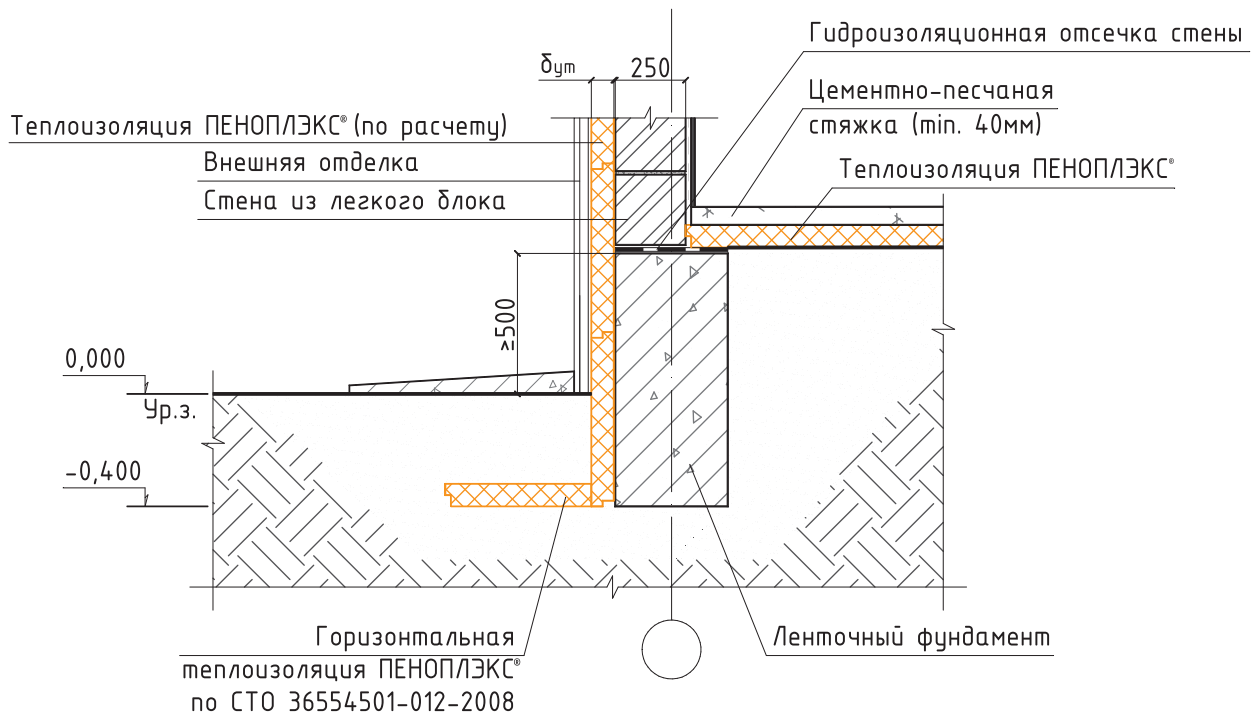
Схема сопряжения малозаглубленного ленточного фундамента и стены из облегченных блоков.
